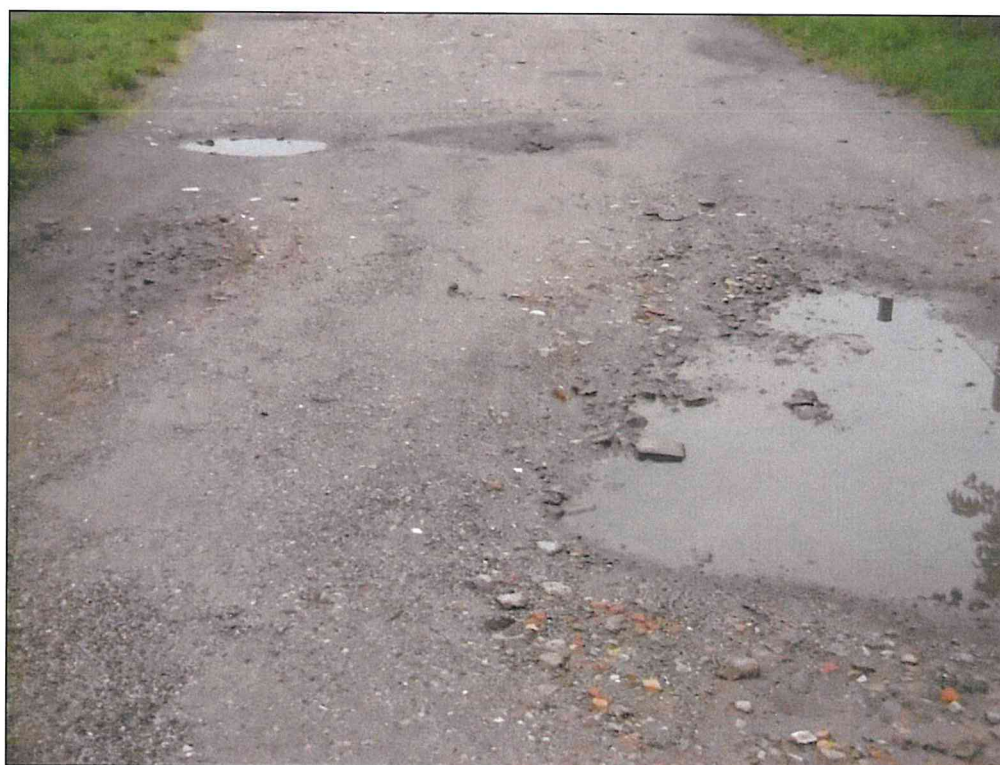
massiv mit Bauschutt befestigte Zufahrt (Flurstück 188)
